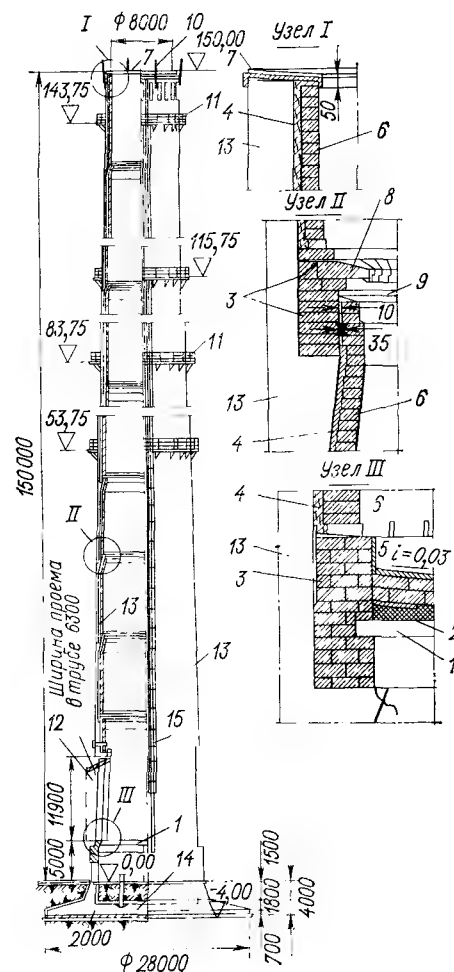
Одноствольная дымовая труба из монолитного железобетона. 1 — перекрытие; 2 — слой шлакобетона; 3 — слой гидроизоляции; 4 — слой теплоизоляции; 5 — термостойкобетонные плиты; 6 — слой кислотоупорного кирпича; 7 — чугунный колпак; 8 — фасонный кирпич; 9 — температурный шов; 10 — молниезащитный отвод; 11 — световод; 12 — газоход; 13 — оболочка трубы; 14 — фундамент; 15 — лестница.
